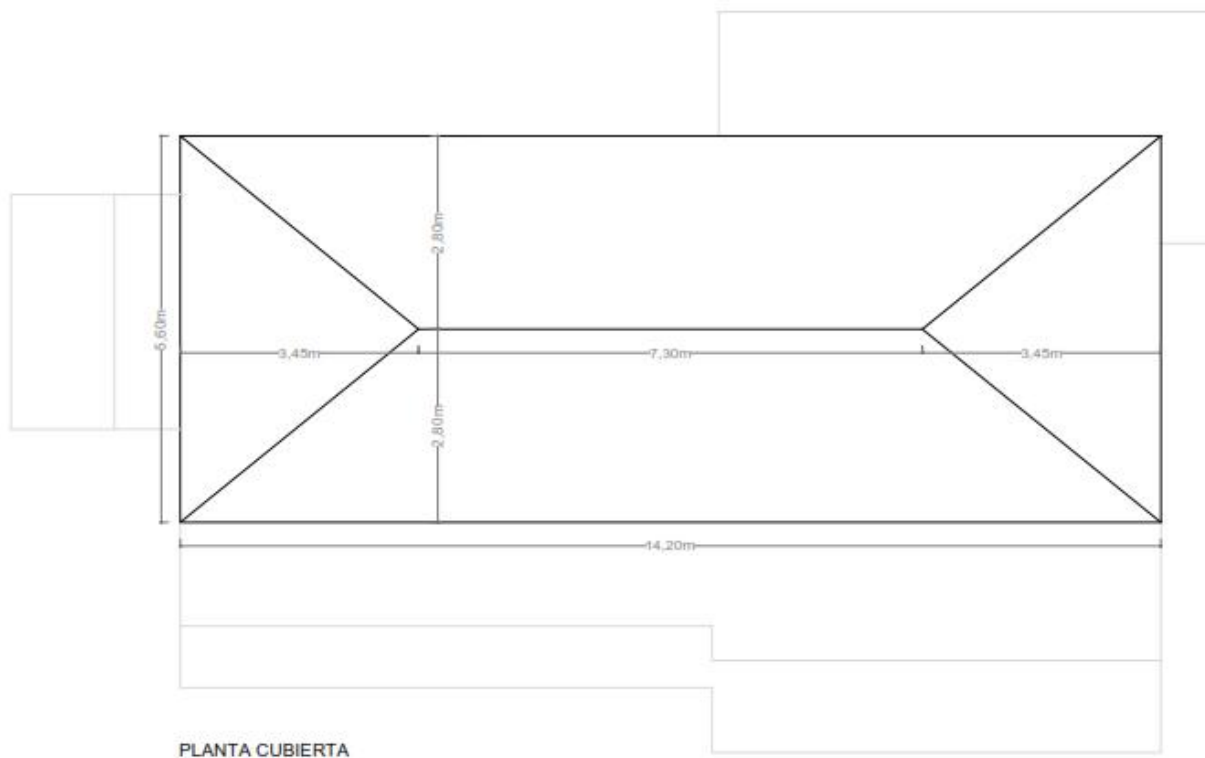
Plano acotado de la planta de cubierta del inmueble objeto.
